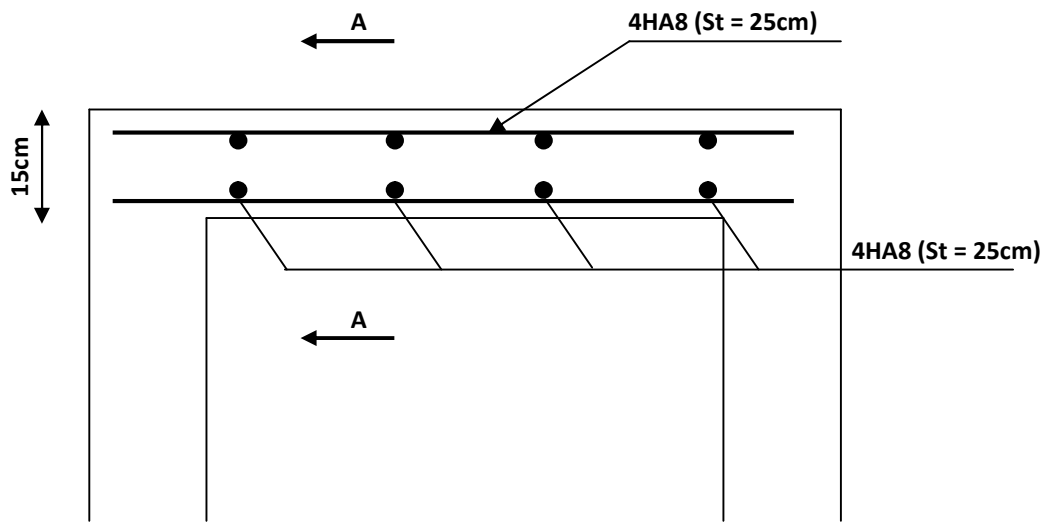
Plan de ferrailage de la dalle de la salle machine
